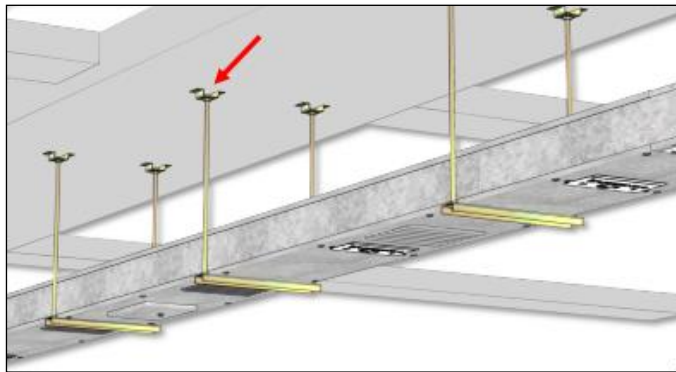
Suportes metálicos com barras roscadas e perfil “U”
